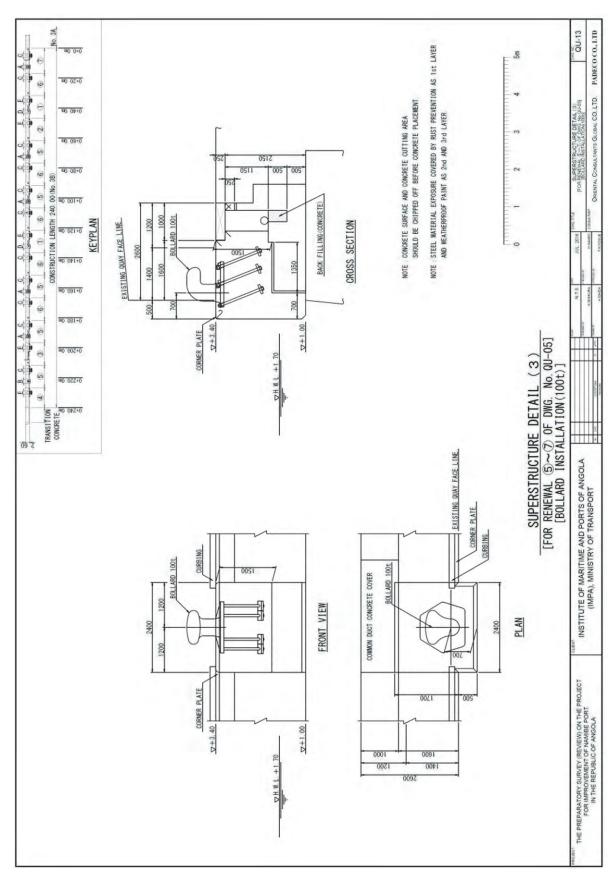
Planta Detalhada da Estrutura Superior (1)
